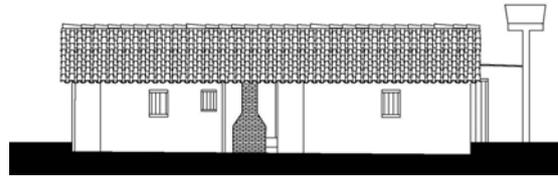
Fachada Sul (Acervo PROAU/FAU/UnB).
